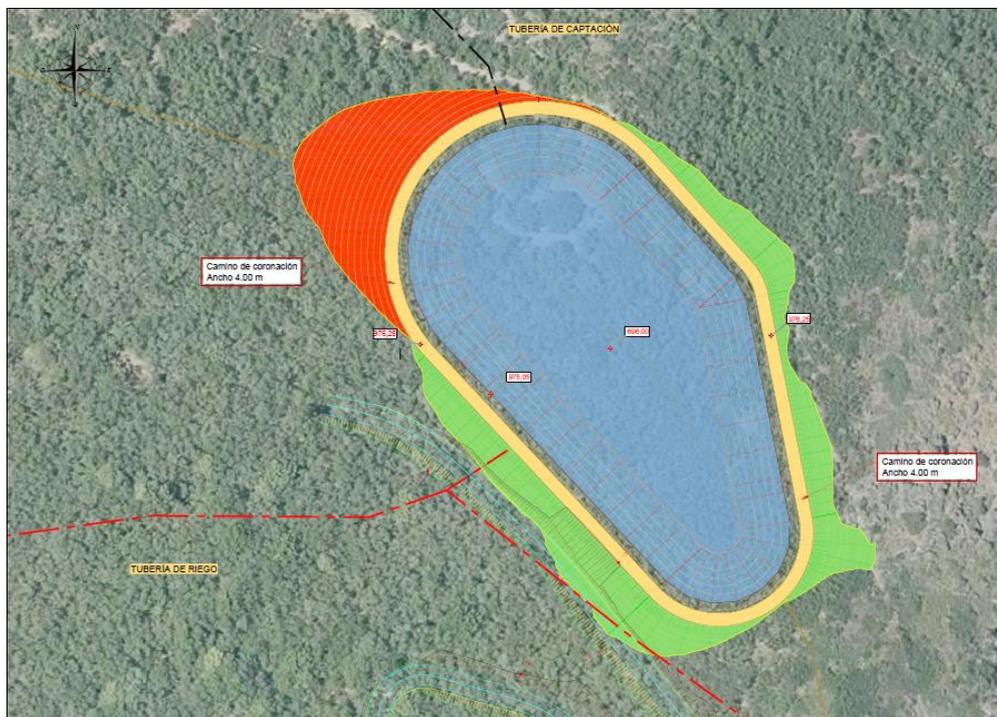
Planta de la balsa proyectada en el Sector Papúos
